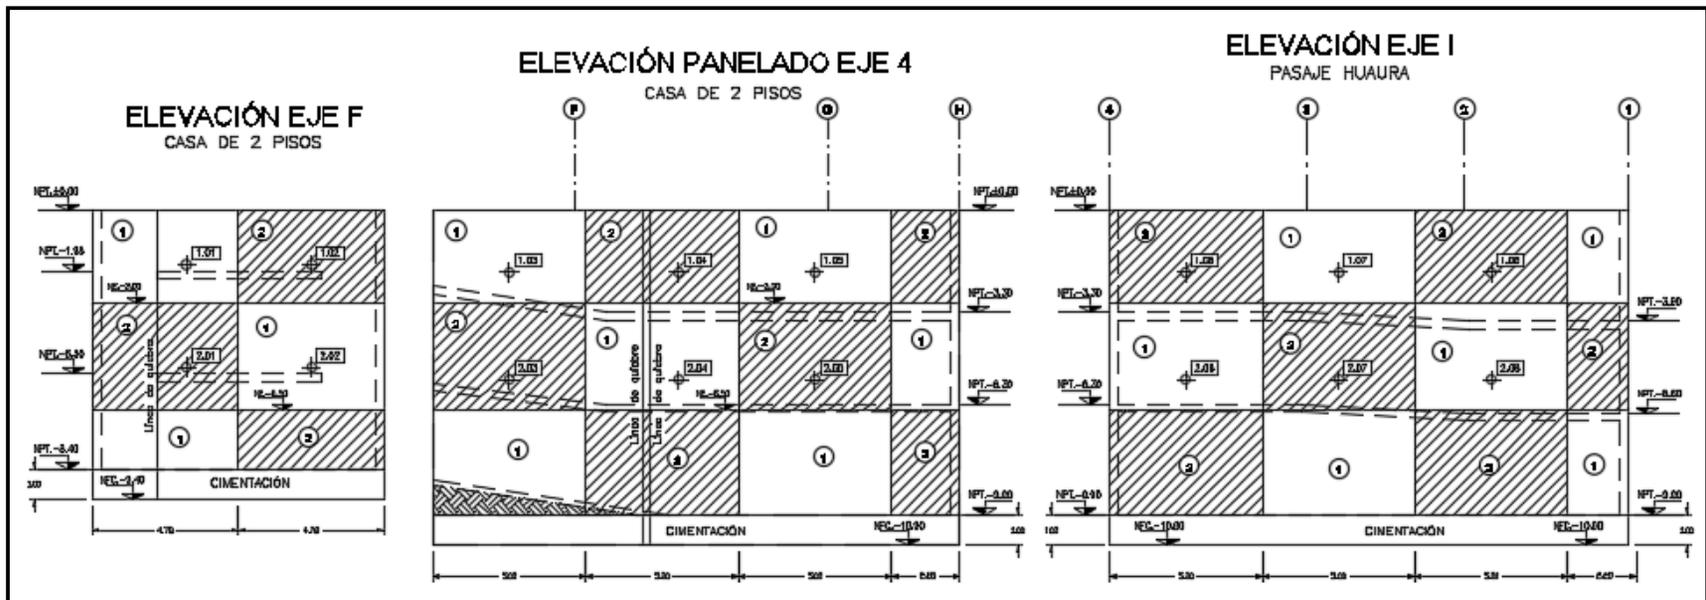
Elevaciones Ejes F, 4 y I obra 2: Edificio Crossland – Muro anclado.
